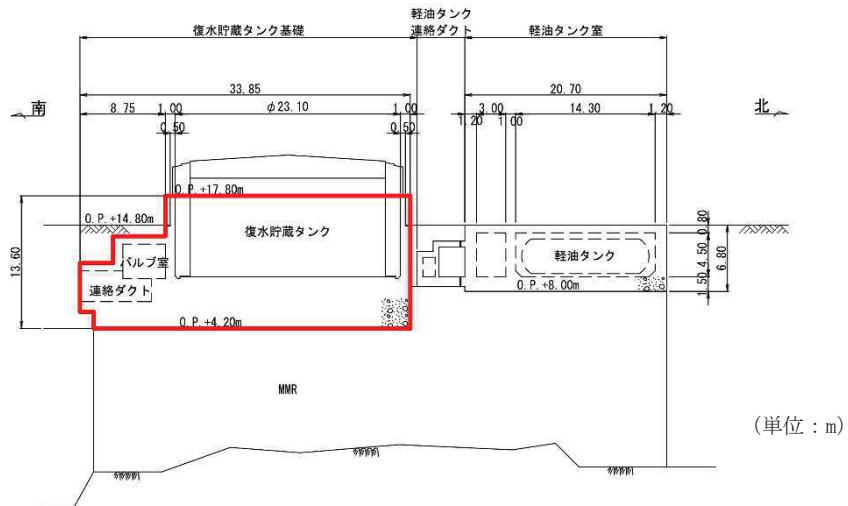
復水貯蔵タンク基礎断面図 (A-A 断面, 南北)
